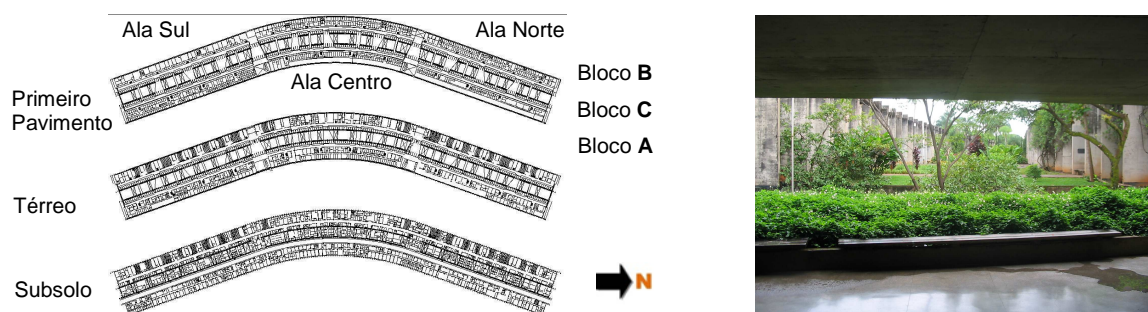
Plantas do Instituto Central de Ciências. Foto 10 – Jardim central (terraço-jardim).
